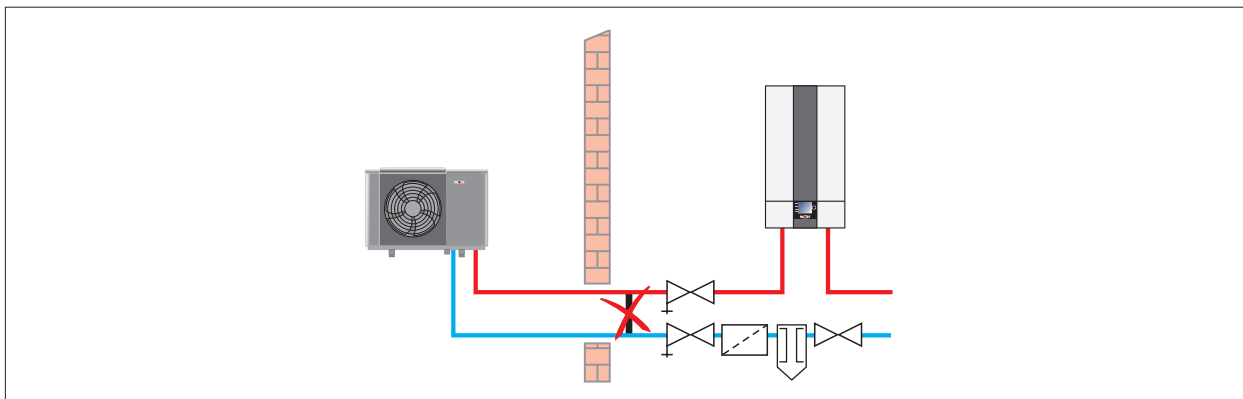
Hydraulická připojení venkovní jednotky dolů
